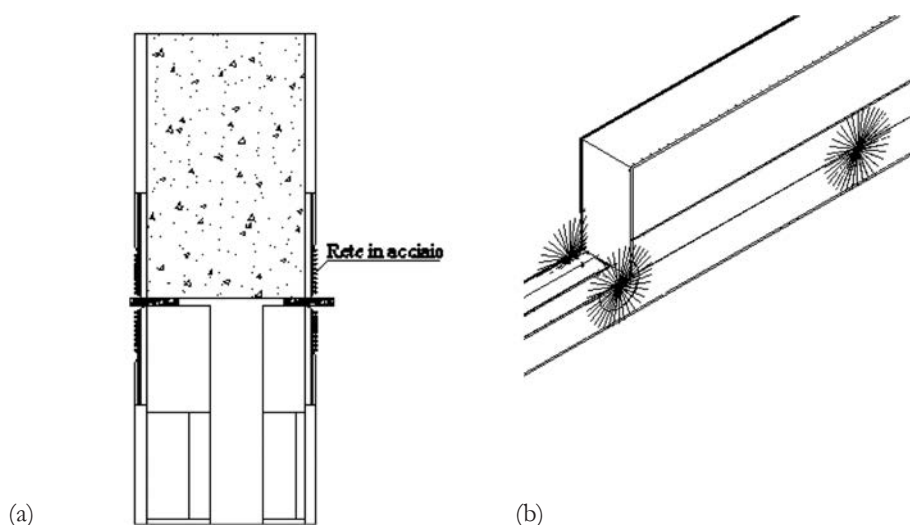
Applicazione di fazzoletto in tessuto unidirezionale in fibre di acciaio e primerizzazione del foro.
